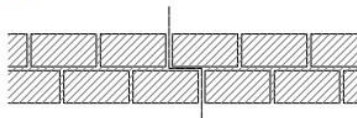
Junta de movimiento con solape. Esquema en planta
